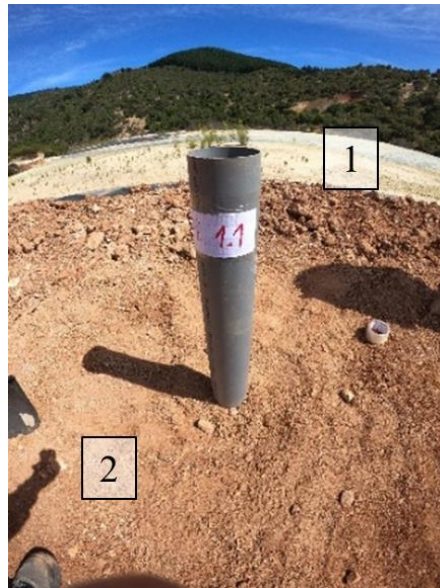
Ensayo de infiltración directa en área circular realizado en muro de embalse de relaves Chépica. 1) material de relaves. 2) suelo del muro del embalse, elaboración propia.
